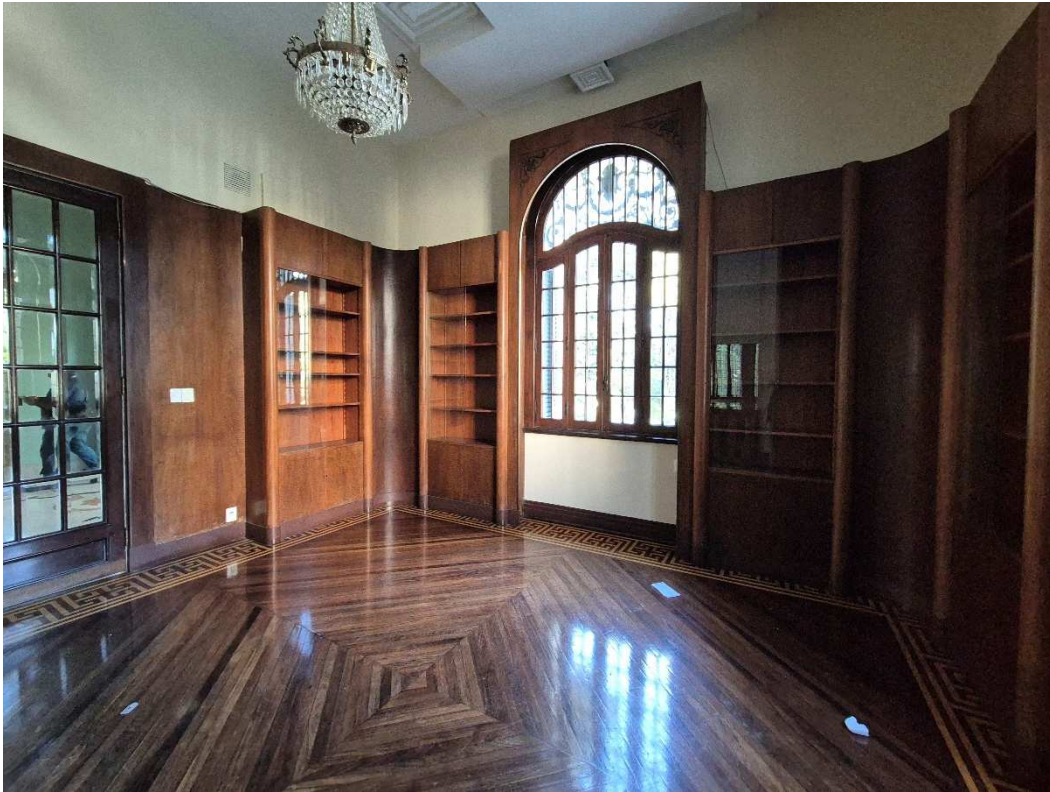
Aspecto interno da edificação principal (Pavimento Térreo).
